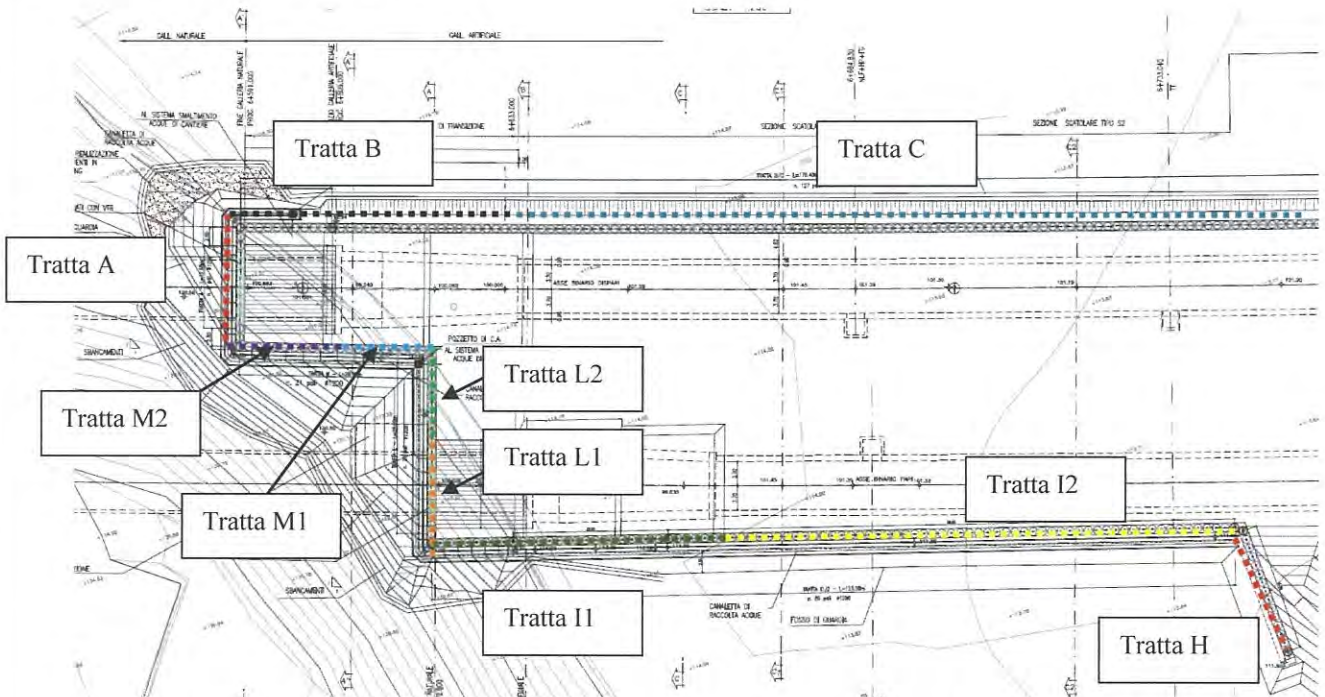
Planimetria con indicazione delle diverse tratte di calcolo in corrispondenza dell'imbocco
